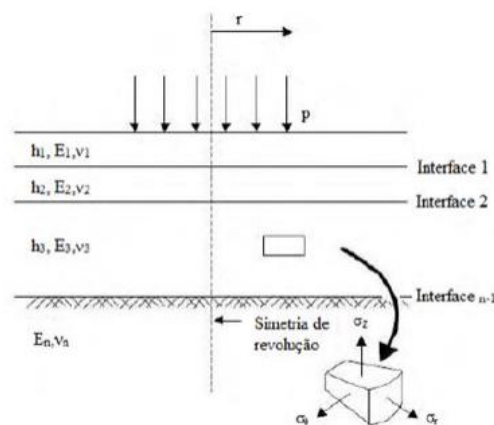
7: Esquema de tratamento da estrutura do pavimento (FUNDEC-IST, 2014)
